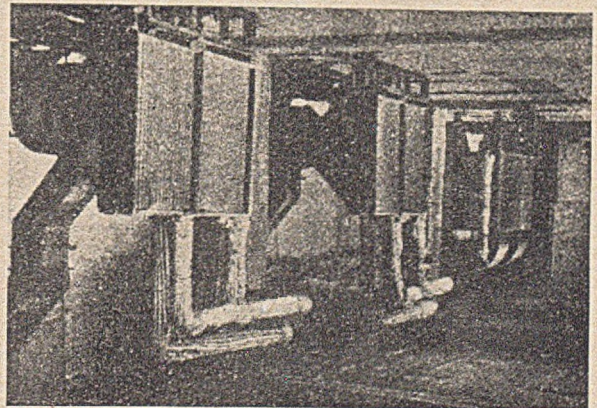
Nagrzewanie betonu w celu umożliwienia wykonywania prac betonowych w okresie zimy.
